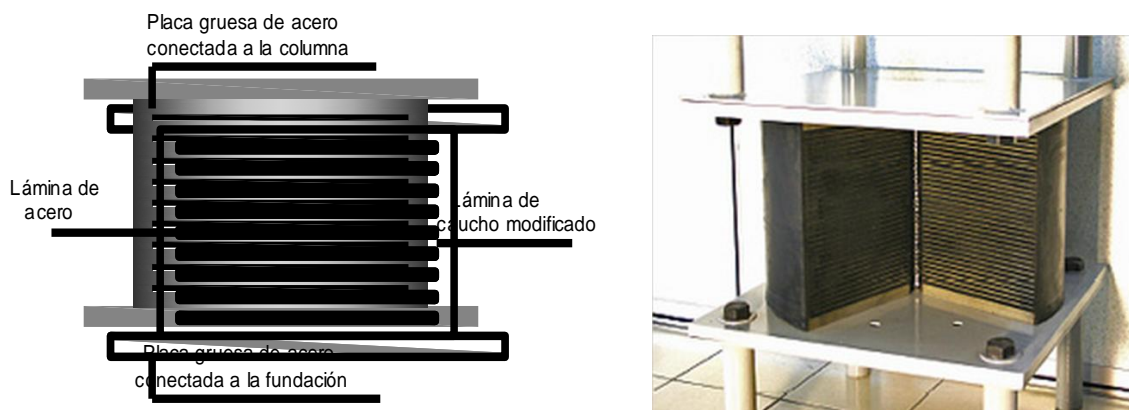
a y b. Componentes del HDR y corte esquemático de un prototipo HDR fabricado por DOSHIN RUBBER - KOSSAN Inc.
